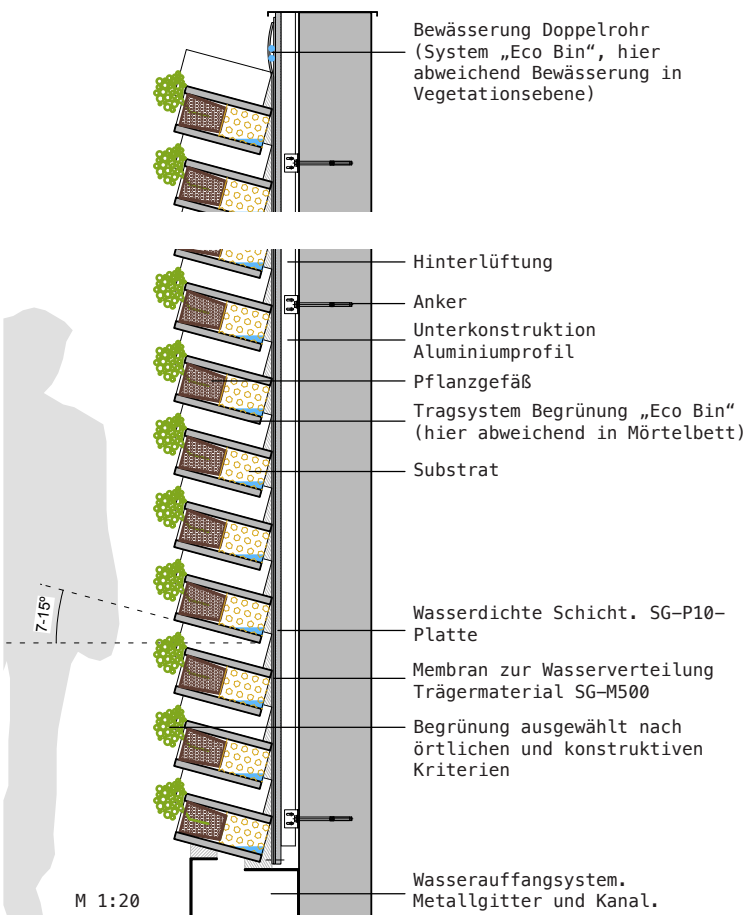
20 selbst. (Nach Schemaschnitten, Ansichten und Fotos interpretiert. Tatsächliche Konstruktion evtl. abweichend.)
